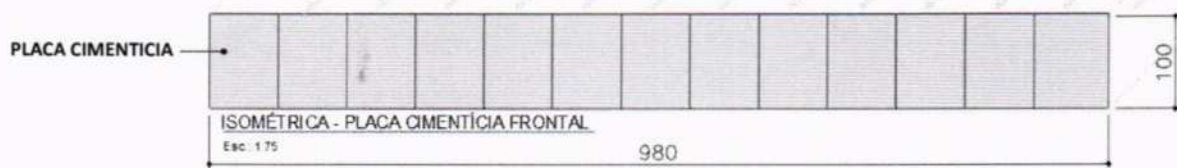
Detalhamento cobertura da fachada da Unidade de Saúde Paulo Kondo em Placas cimentícias.
